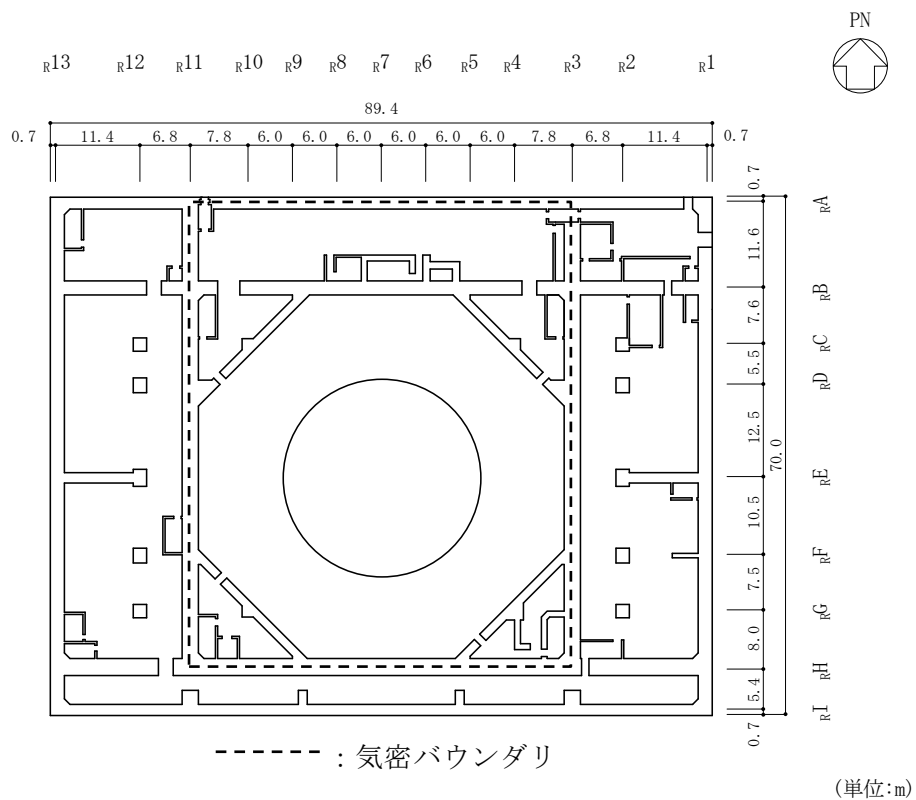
(2) 原子炉建物原子炉棟（二次格納施設）の概略平面図（EL 8.8m）
